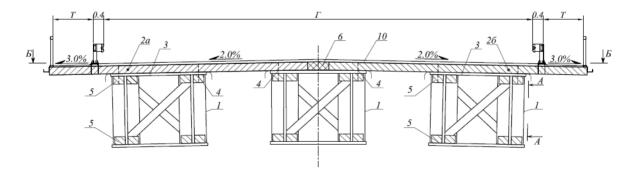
Пролетное строение с железобетонной плитой проезжей части
